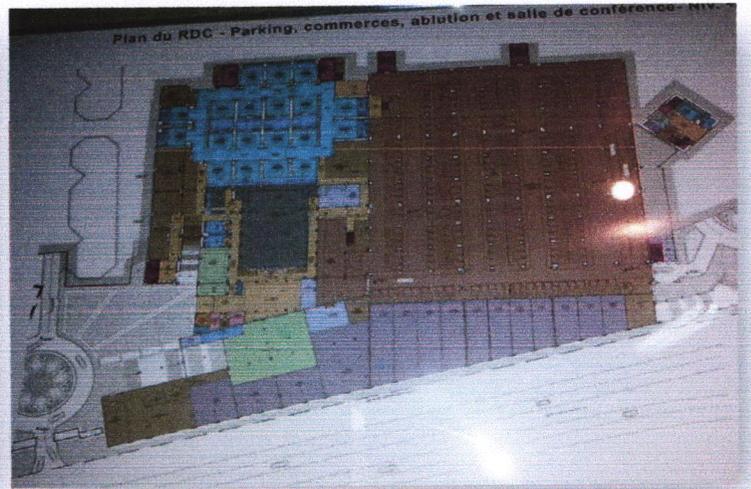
Plan du Parking de la mosquée Ibn Badis.
